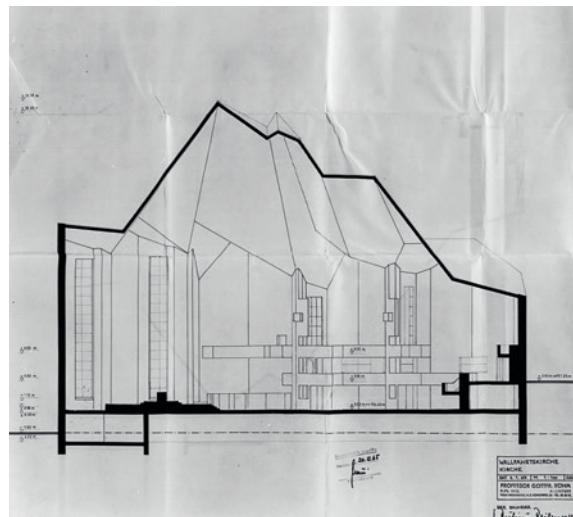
Schnitt der Wallfahrtskirche, Gottfried Böhm, 1965 (Plan: LVR-Amt für Denkmalpflege im Rheinland, Gottfried Böhm)
